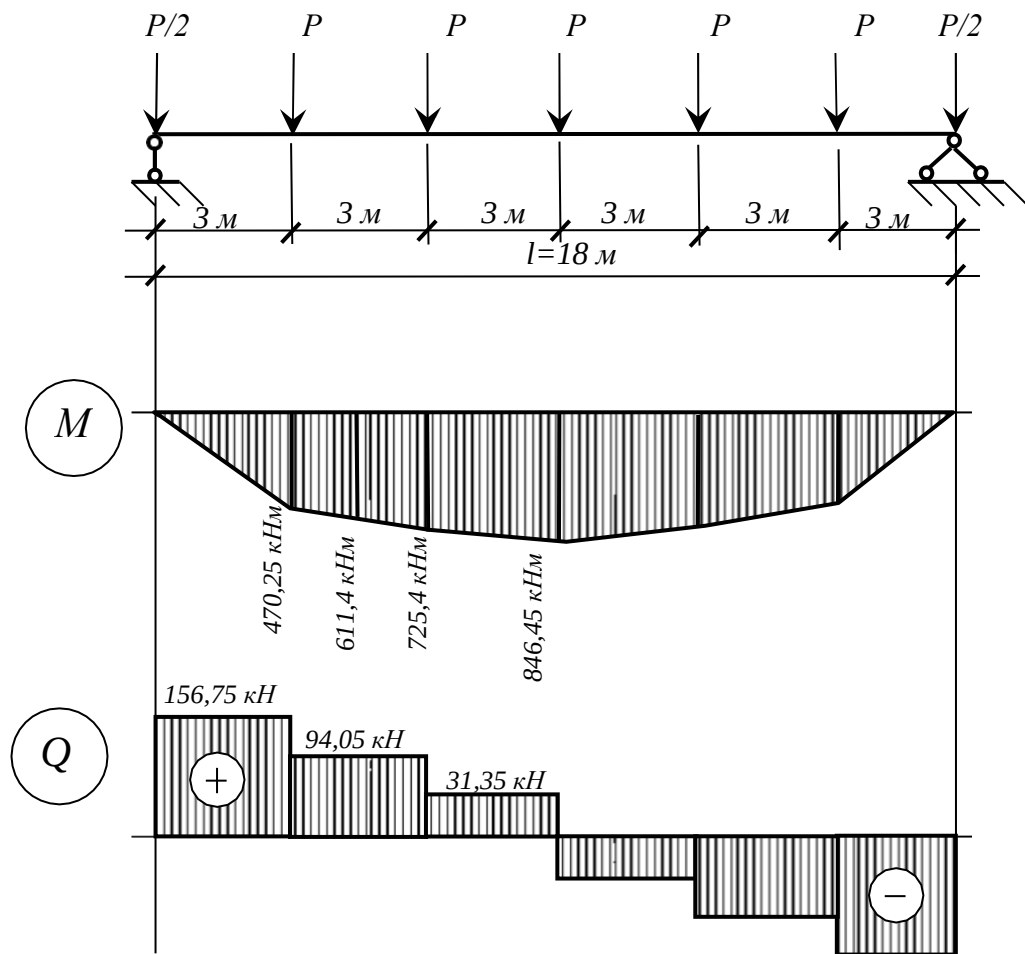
Расчетная схема стропильной балки покрытия и эпюры внутренних усилий M и Q
